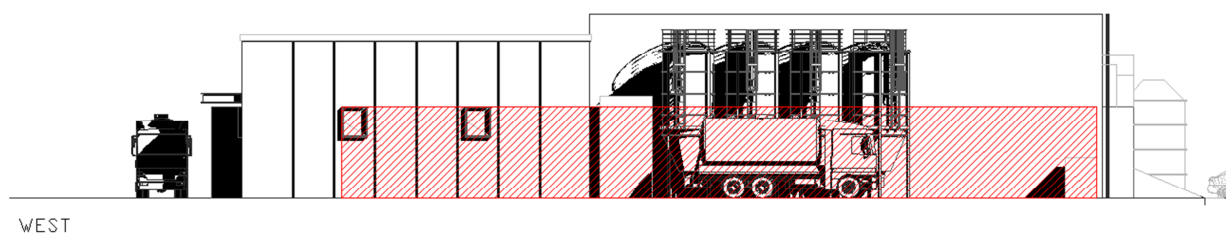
Determinazione delle piastre radianti sul piano radiante 4.
